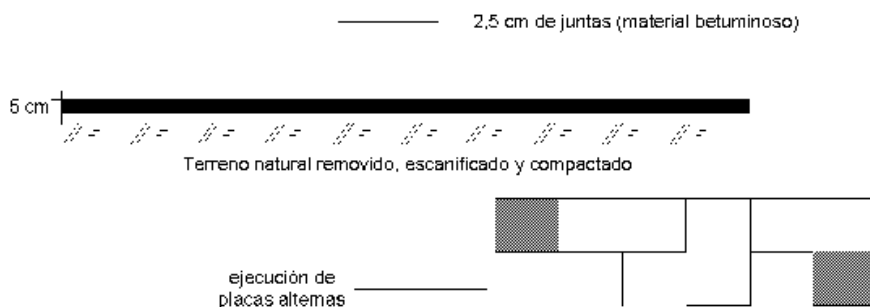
PAVIMENTO CON CONCRETO HIDRÁULICO.
